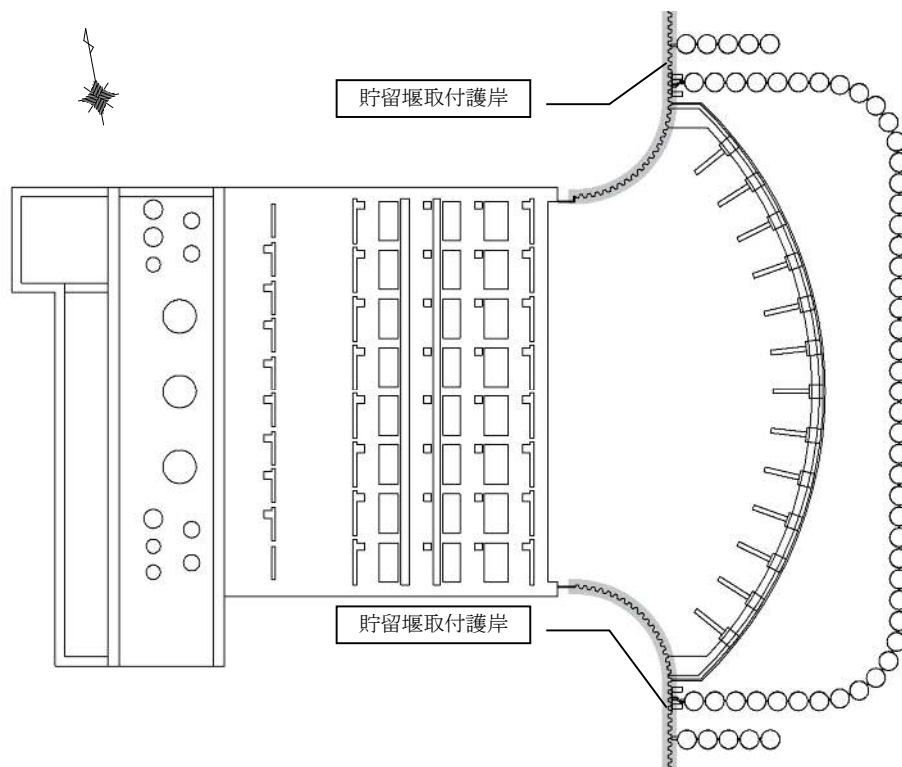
(2) 貯留堰取付護岸の平面配置図（拡大図）
